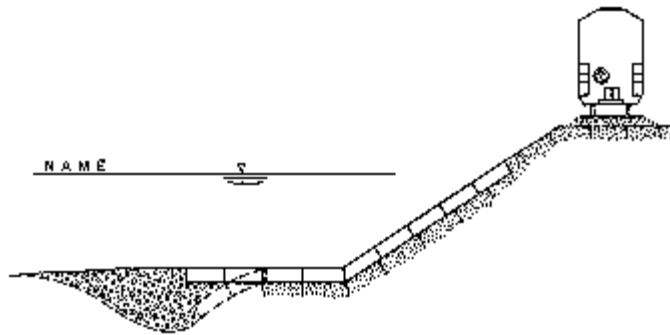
Revestimiento marginal cimentado sobre una platea
